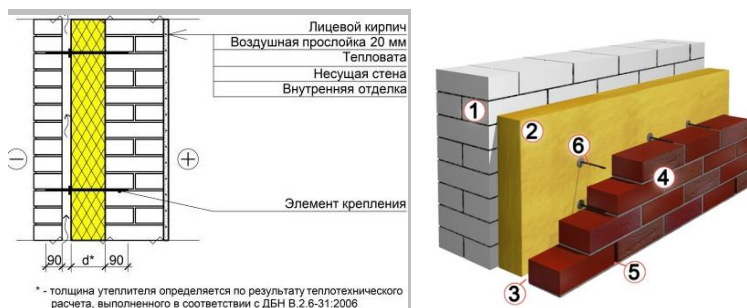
Схема утепления при многослойной кладке: 1 – несущая стена; 2 – утеплитель; 3 – лицевой кирпич; 4 – элемент крепления.
